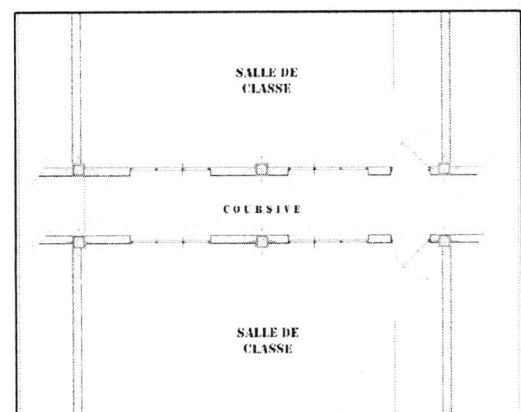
Plan des salles de cours de la typologie de plan à corridor.
